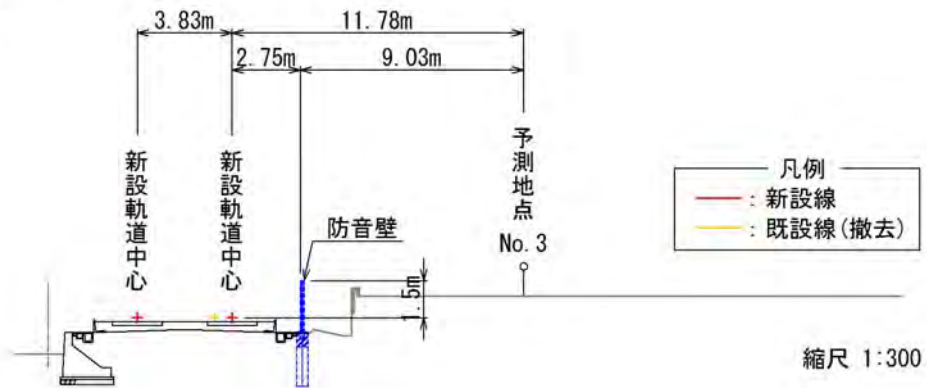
(3) 予測平面・断面図(予測地点 No. 3)
